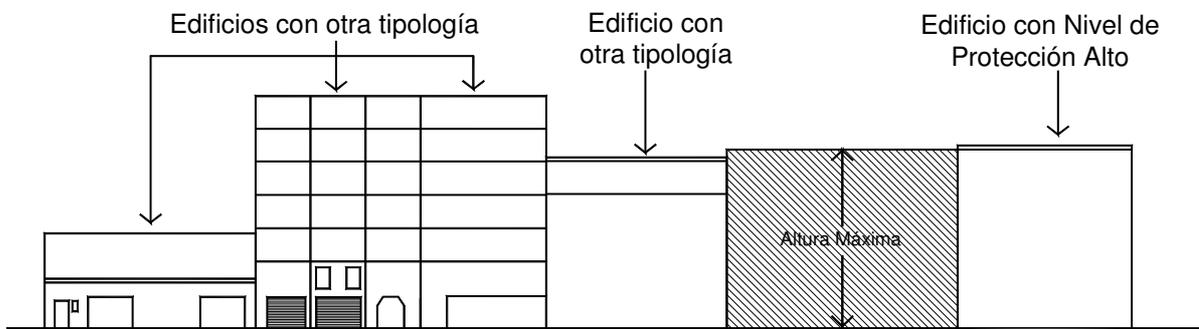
Gráfico que ilustra el Criterio B para determinar alturas en la Zona Centro
